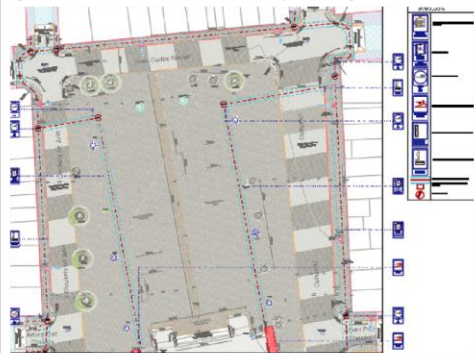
Sector 1 de planimetría accesibilidad La Tirana
